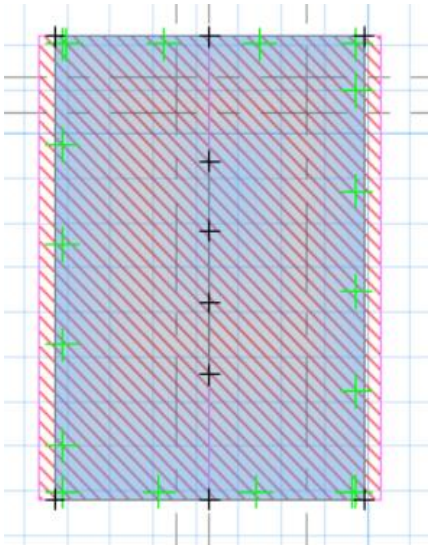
Design Strip en fundación con dirección longitudinal (Strip Layer A).
